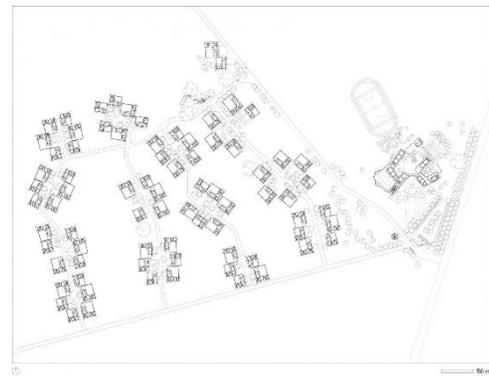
Benga Riverside Residential, planta de implantação de equipamentos e habitações.
